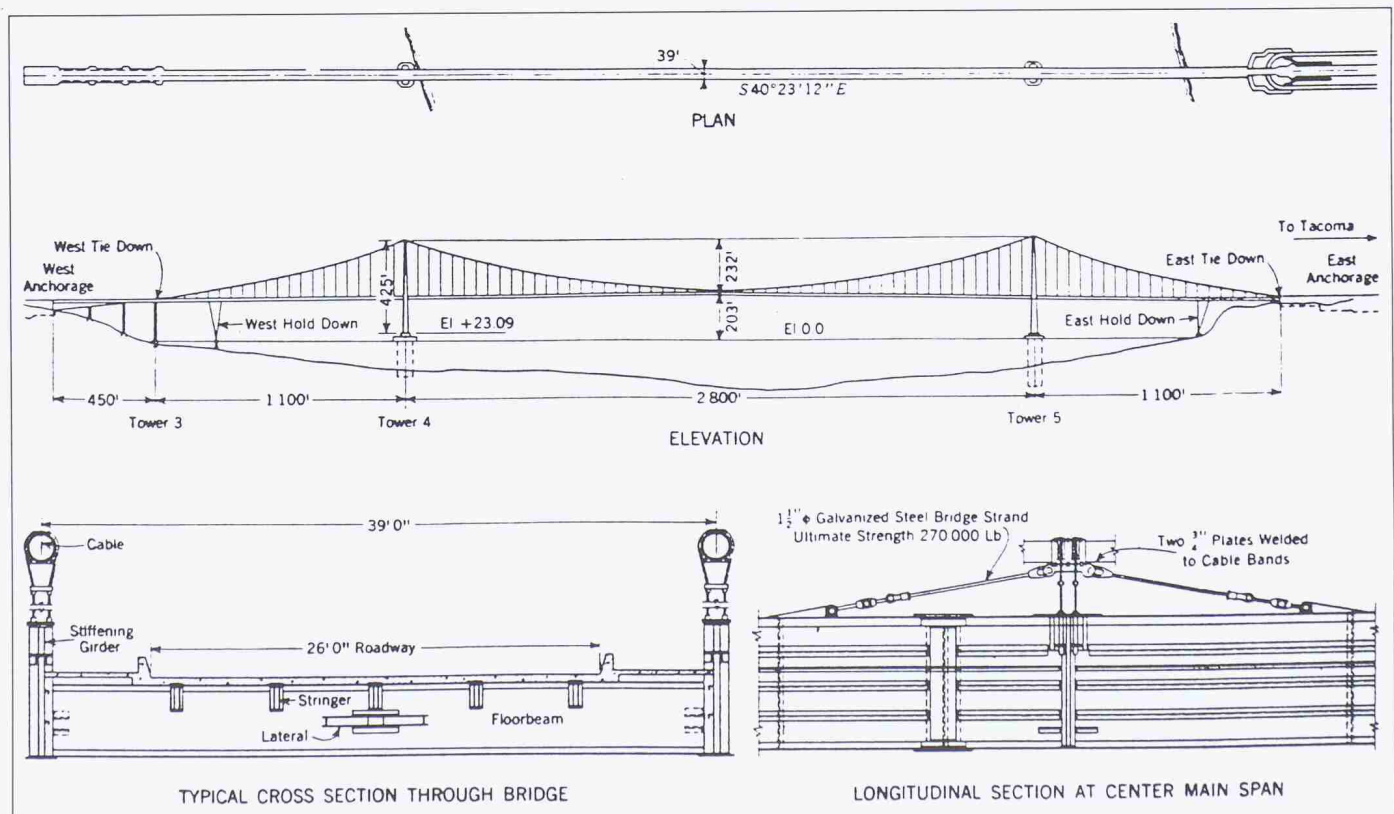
Grundriss, Längs- und Querschnitt der ersten Tacoma Narrows-Brücke (1938-40)
